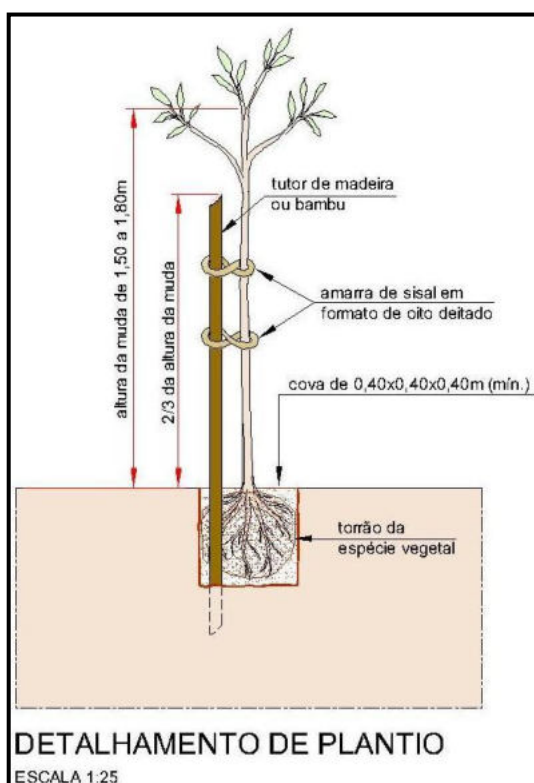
Detalhamento de Plantio.
